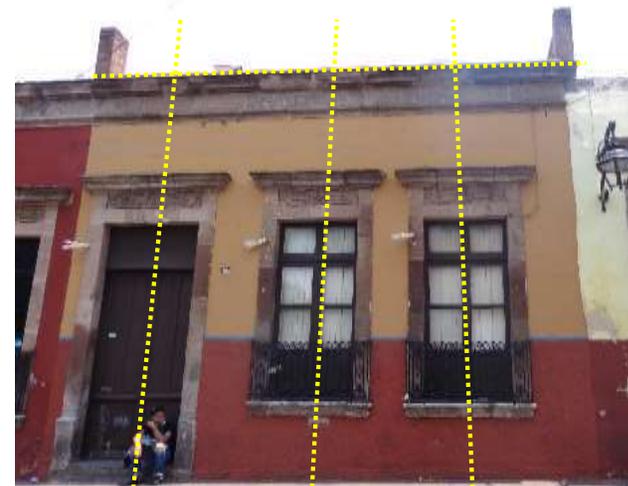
Calle plan de Ayala, barrio de San José, centro histórico de Morelia; se percibe la estructura sobre la azotea (por la autora 10/May/2020).
